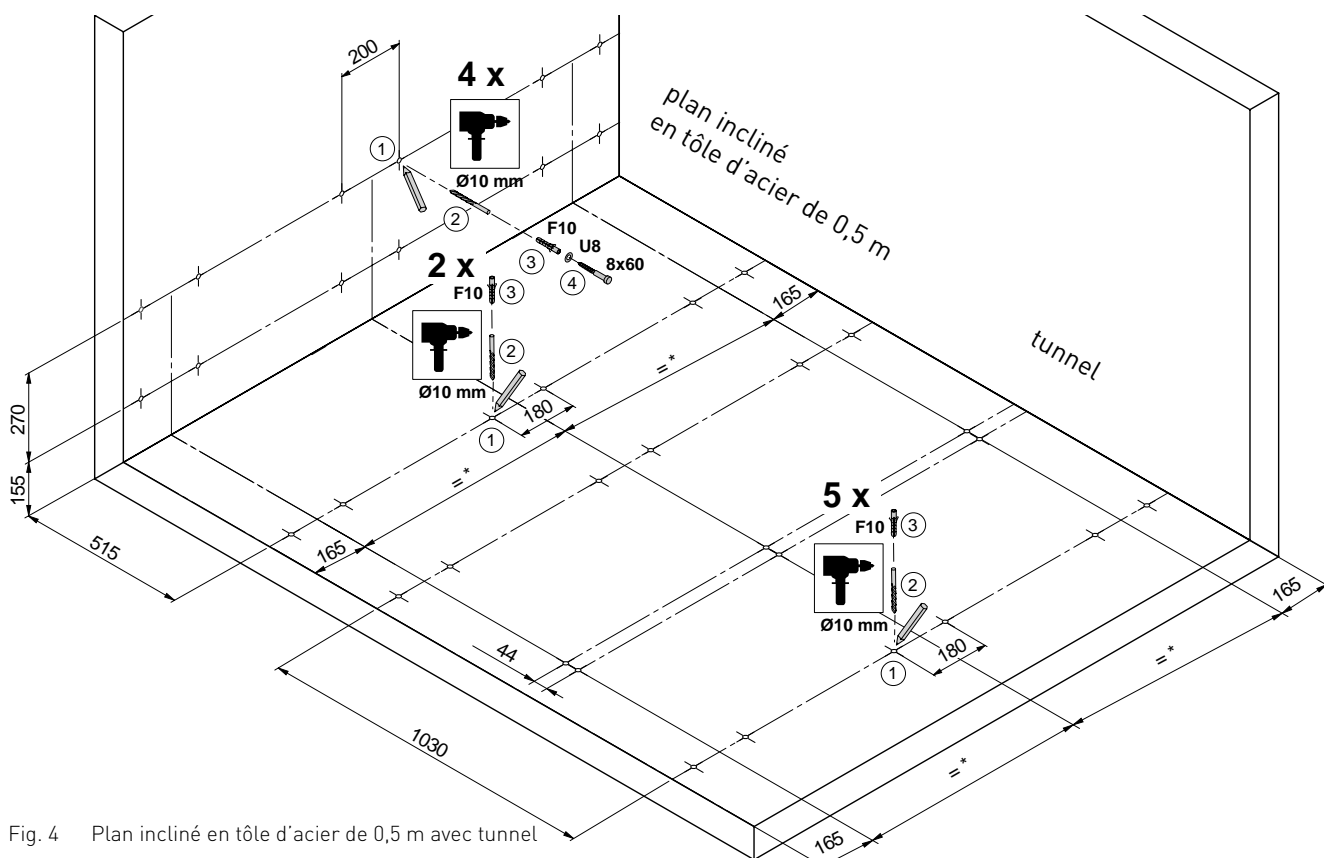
Plan incliné en tôle d'acier de 0,5 m avec tunnel
